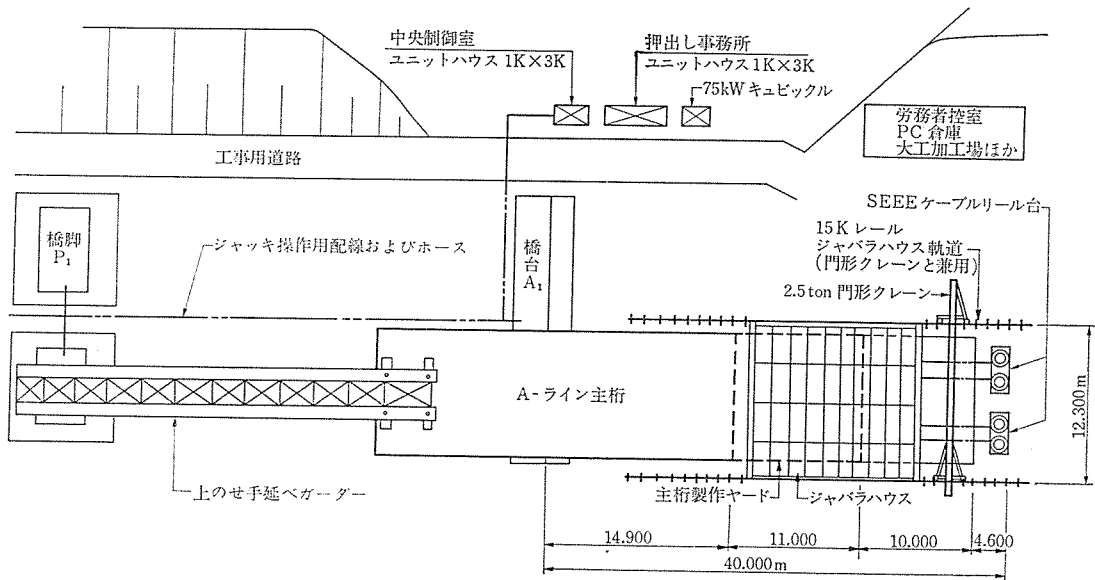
ヤード配置図 (A₁ 側, Aライン施工時)
